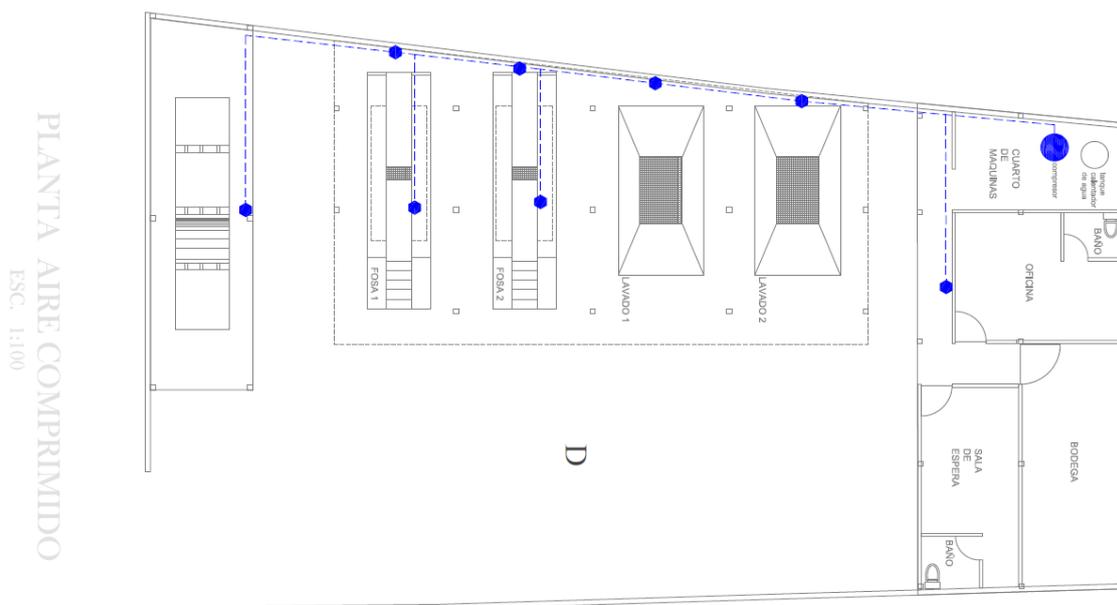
Plano de planta de aire comprimido, descripción de la instalación de aire comprimido del centro de auto lavado.
